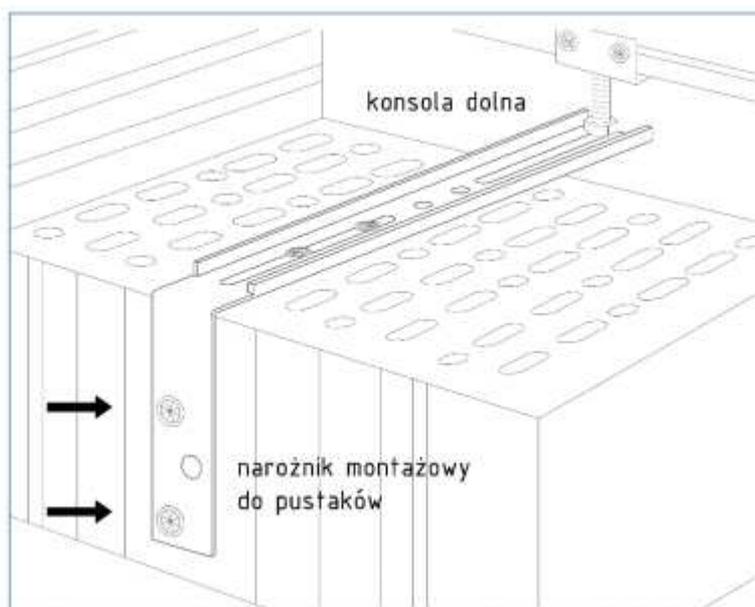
Exemple de fixation de la console inférieure au mur en parpaings
